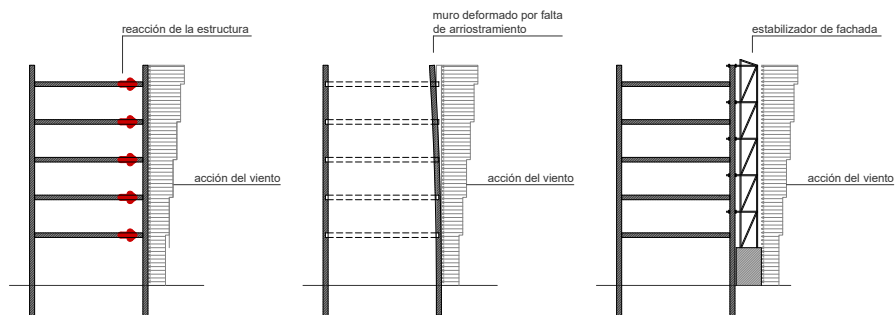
Un estabilizador de fachada reemplaza a los forjados y asume sus funciones de arriostramiento horizontal de la fachada.
